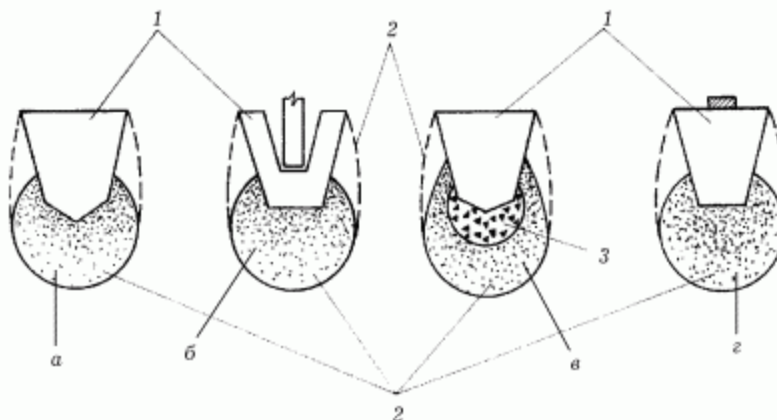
Устройство фундаментов в втрамбованных котлованах: а – способом заполнения бетоном в распор (обычный фундамент); б – установкой сборного элемента (обычный фундамент); в – заполнением монолитным бетоном (фундамент с расширенным основанием); г – фундамент с расширенным основанием; 1 – фундамент в втрамбованном грунте; 2 – уплотненный грунт; 3 – втрамбованный жесткий материал.
